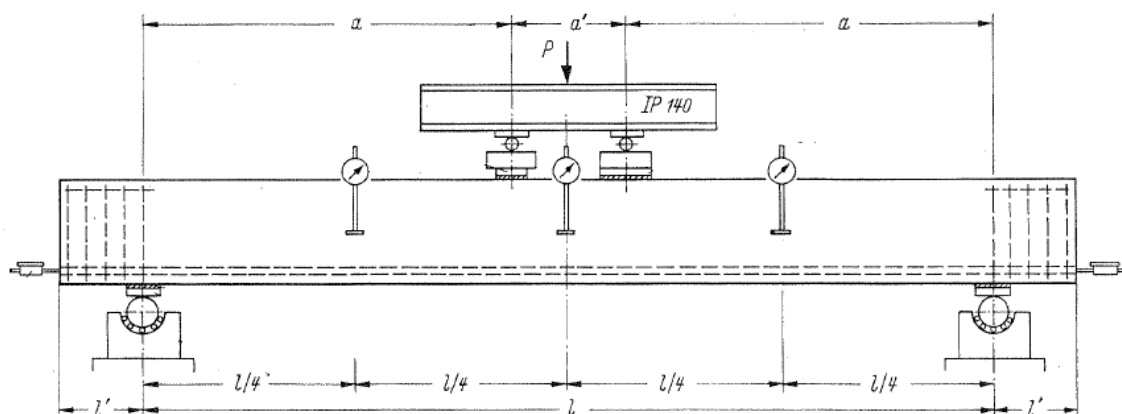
Geometria e configuração das vigas Leonhardt & Walther (1962) (Malm, 2006).
